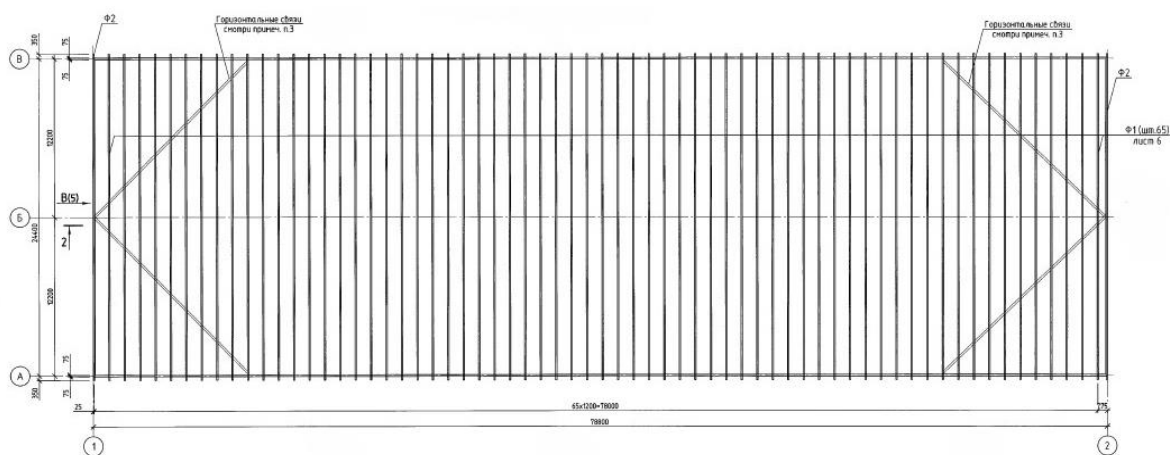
Схема деревянного каркаса по верхнему поясу строительных ферм
